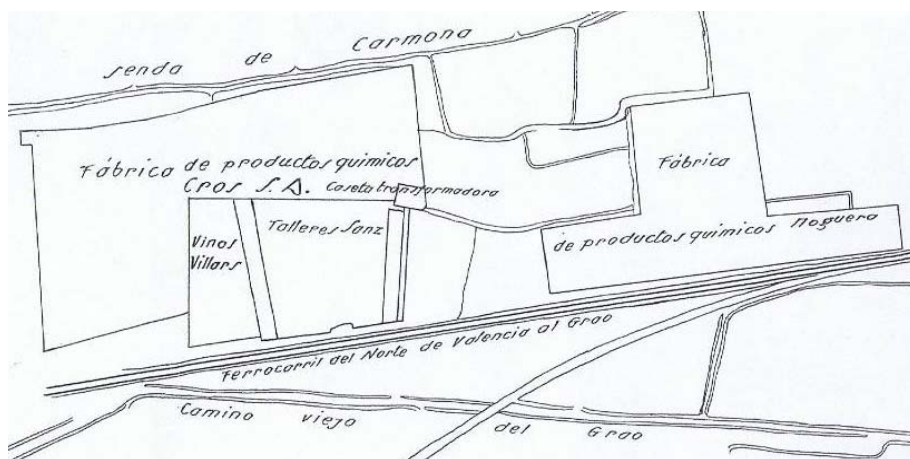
Plano situación de proyecto del año 1930.<sup>429</sup>
